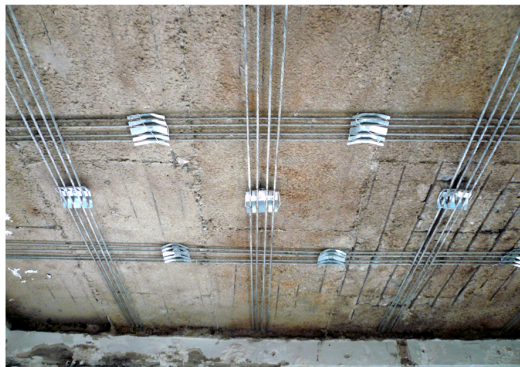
Forjado unidireccional y losa armada con sistema de tendones instalado
